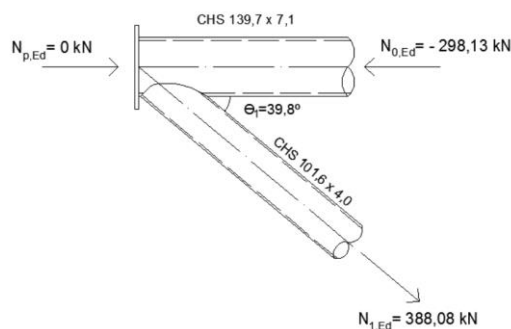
8 – JUNTA 1 – PORMENORES [12]
